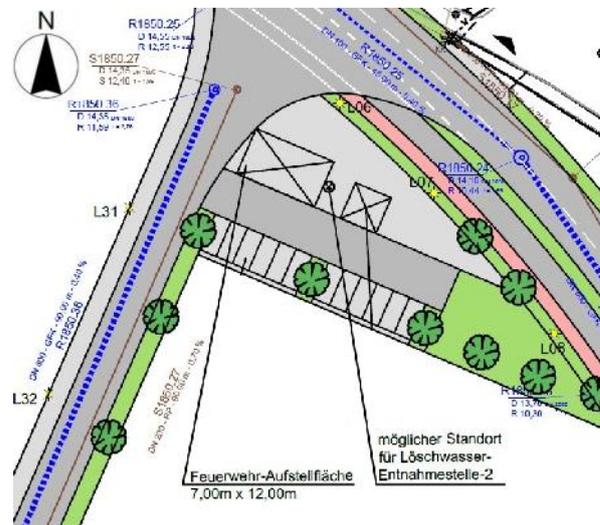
Lage eines möglichen Standortes für eine Löschwasserentnahme ist im Norden des Plangebiets nahe der „Tangstedter Chaussee“, auch über öffentliche Verkehrsflächen erreichbar
